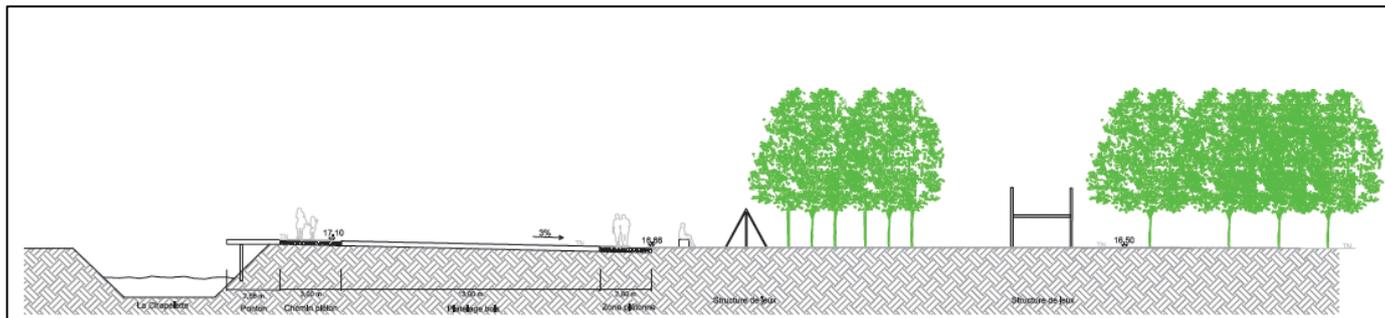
Coupe de principe paysager au niveau des aires de jeux
